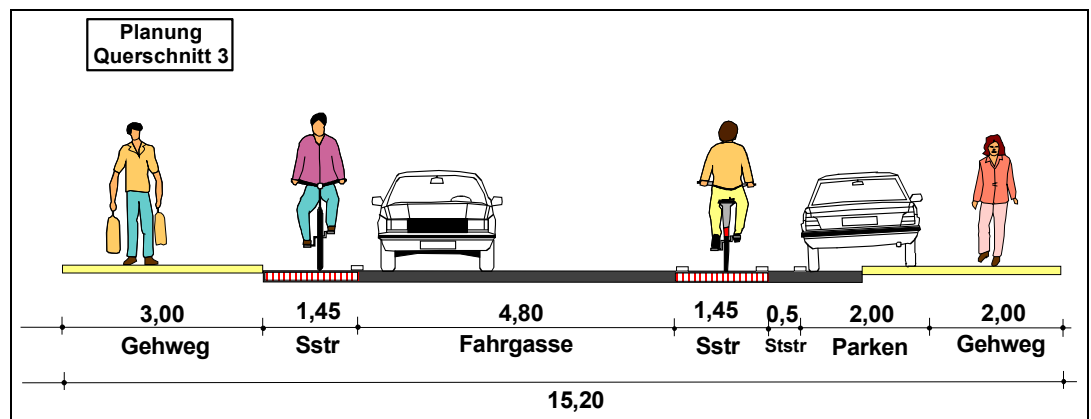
Abschnitt 2 – Planung für Abschnitte mit Parkständen
